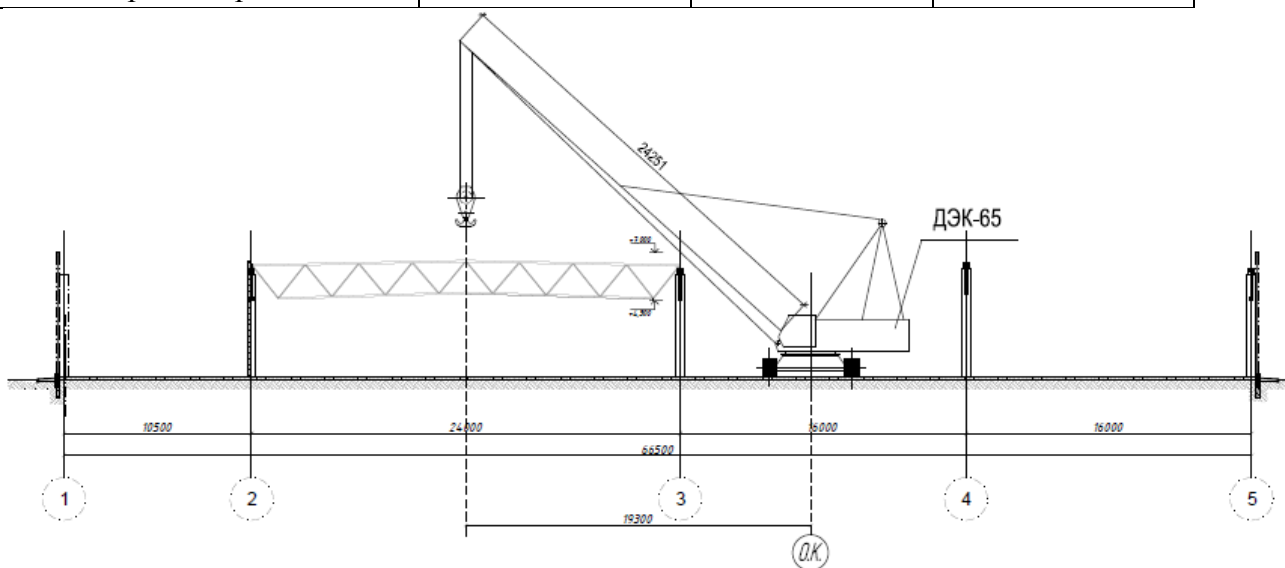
схема расположения крана при монтаже ферм покрытия
